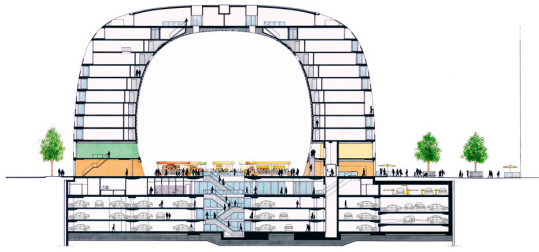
Market Hall, Rotterdam. Sezione trasversale.
